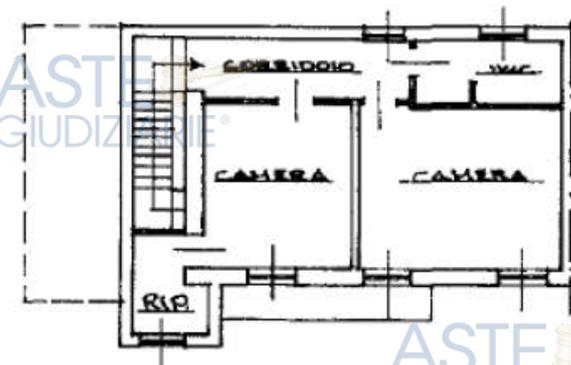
Estratto di planimetria catastale del 07.12.1993 n. T50523
